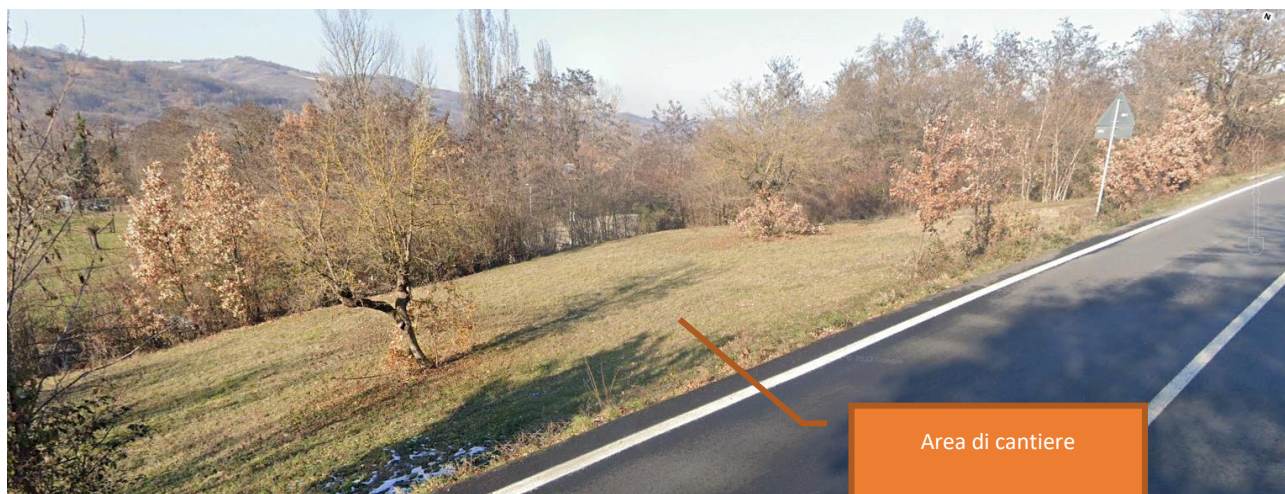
ingresso da strada provinciale verso area di cantiere 2
